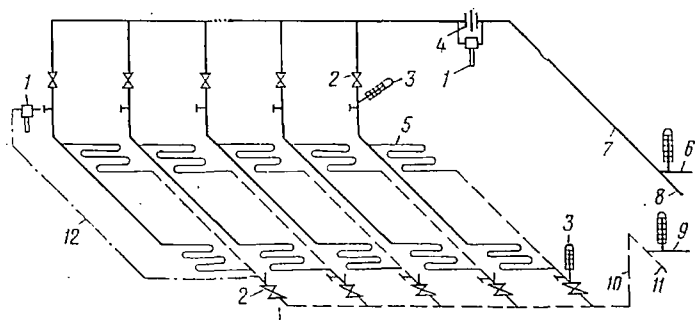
Схема трубопроводов левой ветви системы напольного отопления ангара:
